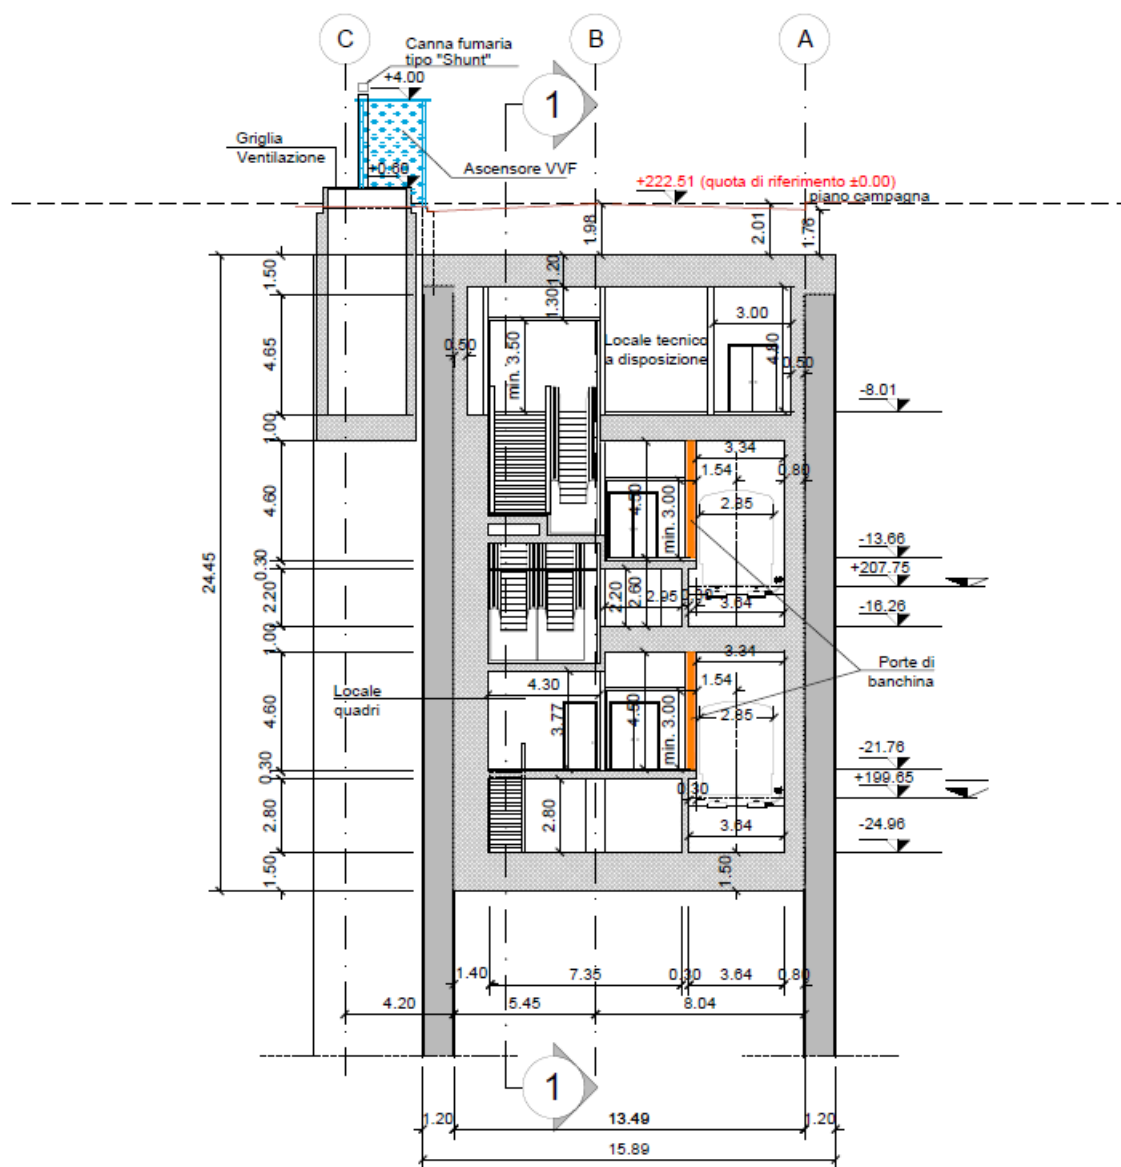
Sezione trasversale della stazione Cimarosa/Tabacchi
